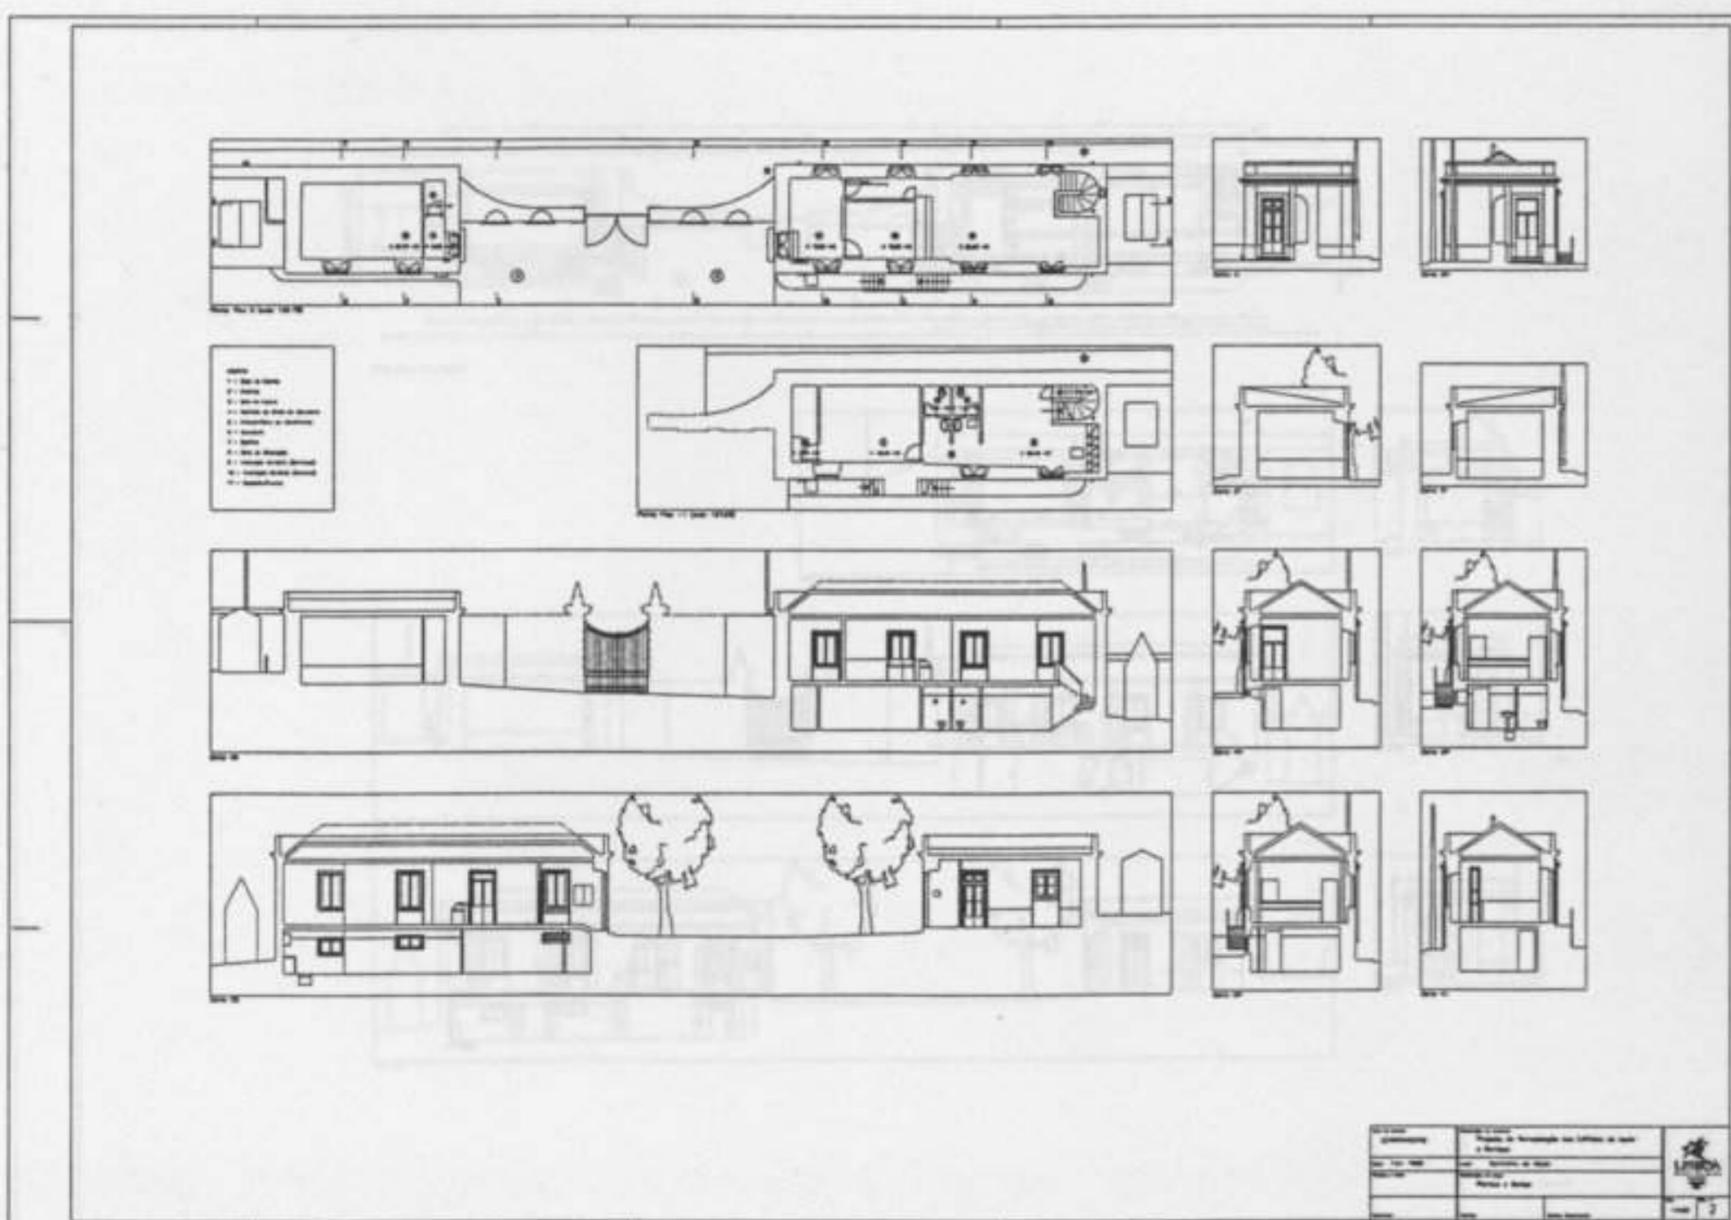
Levantamento - Plantas e Cortes - Esc. 1/100 - Des. nº 2.
